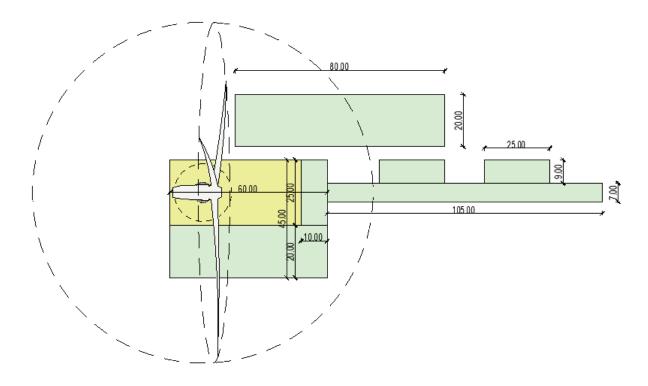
Particolare planimetrico della piazzola di installazione degli aerogeneratori
